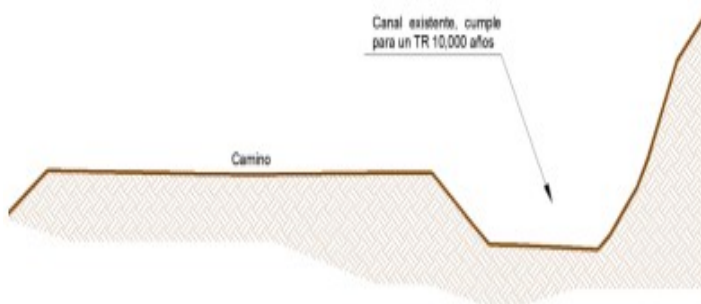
Sección de canal de desvío 3 vista norte a sur
